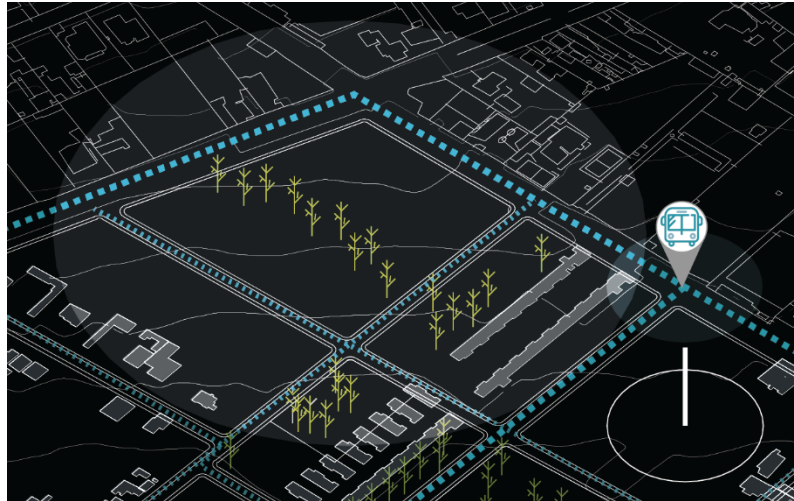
Plan masa barrio José Terán (Cuito, 2017)
